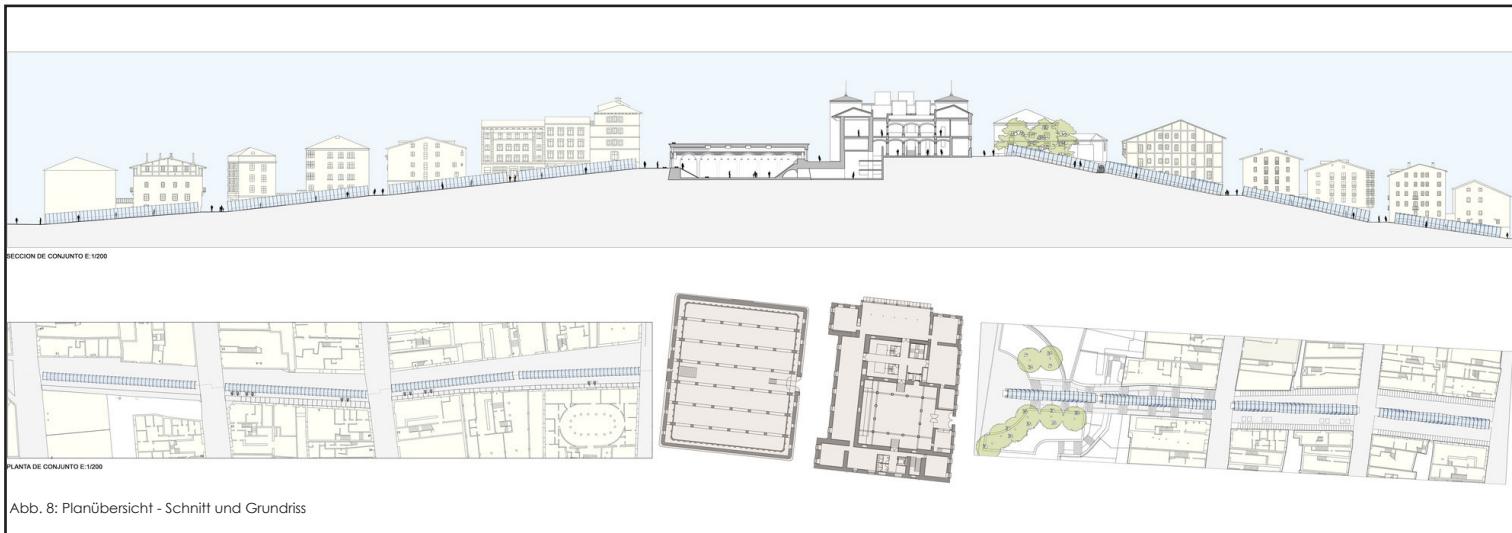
Planübersicht - Schnitt und Grundriss
